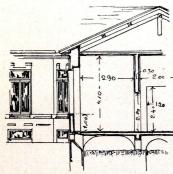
Sezione delle celle. del pavimento come 1:8.
